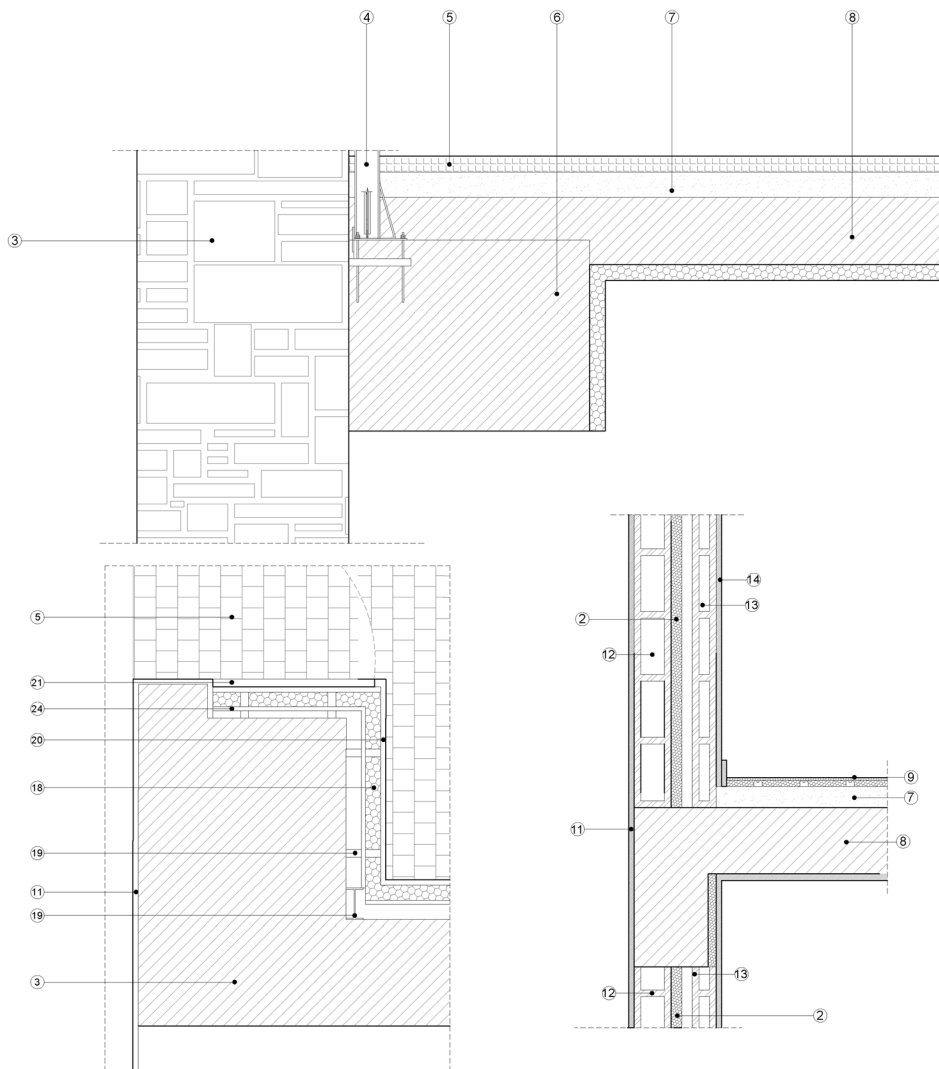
| Pormenores construtivos: Fundações e solução estrutural das paredes.
